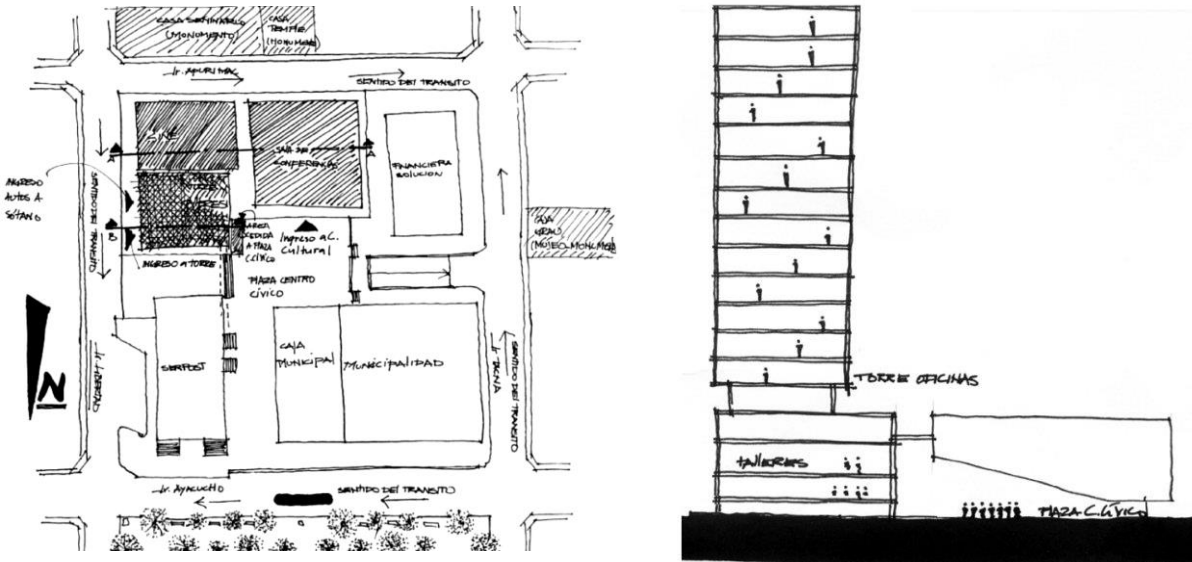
Emplazamiento y sección esquemática del centro cultural propuesto.
